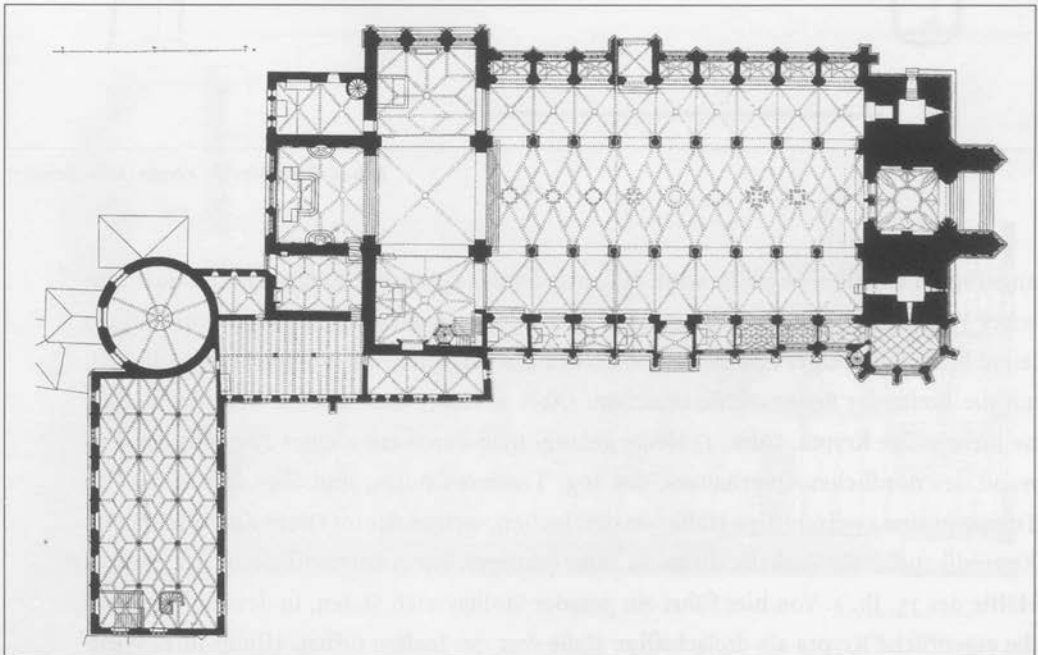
Grundriss des Münsters und der Nebenbauten
